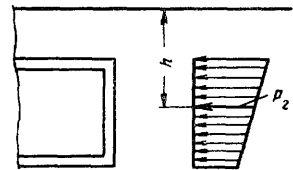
Схема горизонтальной нагрузки на подземное сооружение от транспорта
